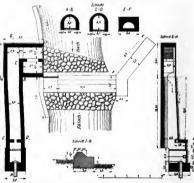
Die Wasserfassungsanlage. Grundriss und Schnitte. - Masstab 1 : 300.
